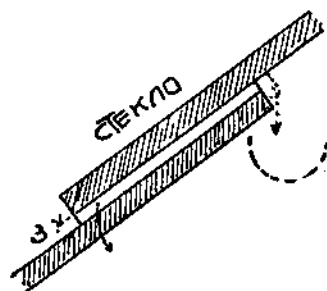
Деталь свеса стеклянной кровли светового фонаря.
